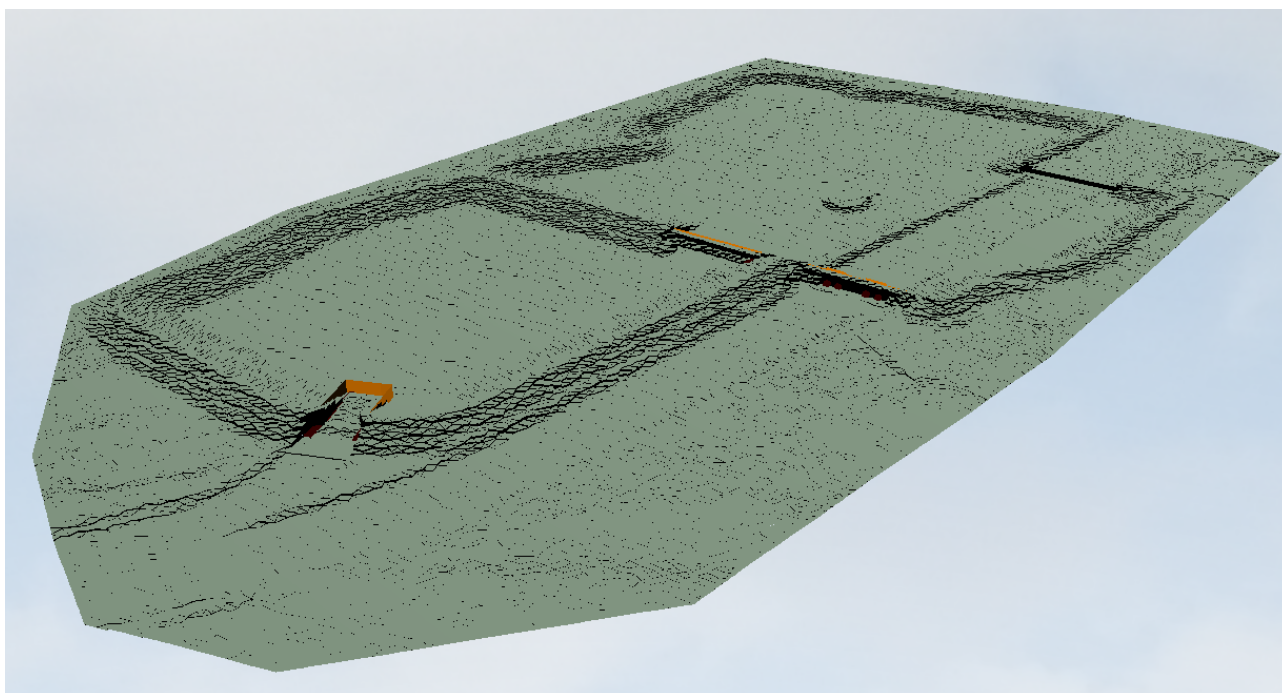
Planimetria del modello bidimensionale della cassa di espansione del T. Baganza
